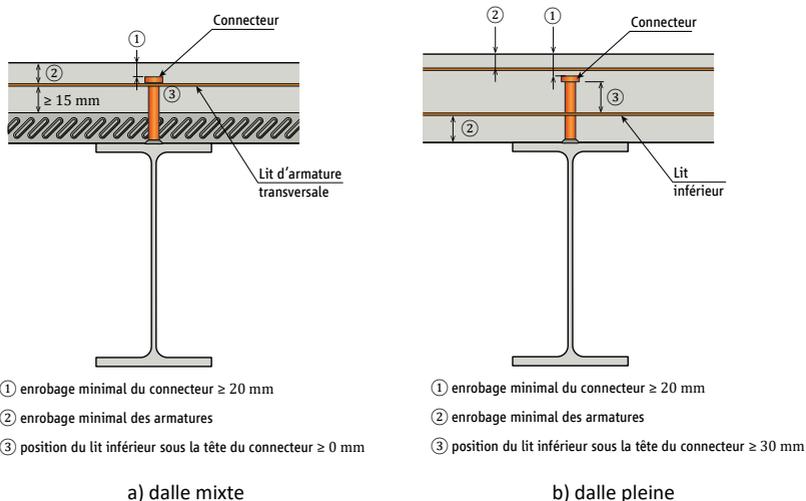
Règles de positionnement des armatures transversales dans la dalle
